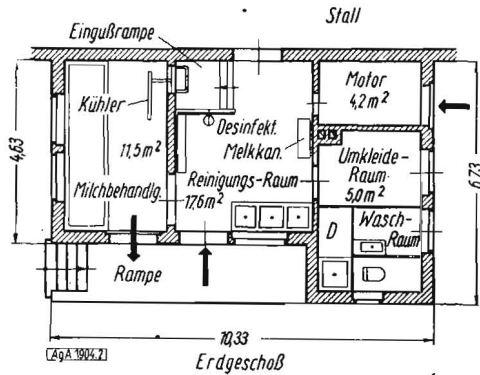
Angebautes Milchhaus. Unterkellert mit Rampe. Für 60 Kühe. Kühlung mit Flächenkühler oder im Kannenkühlbecken mit tiefgekühltem Wasser
